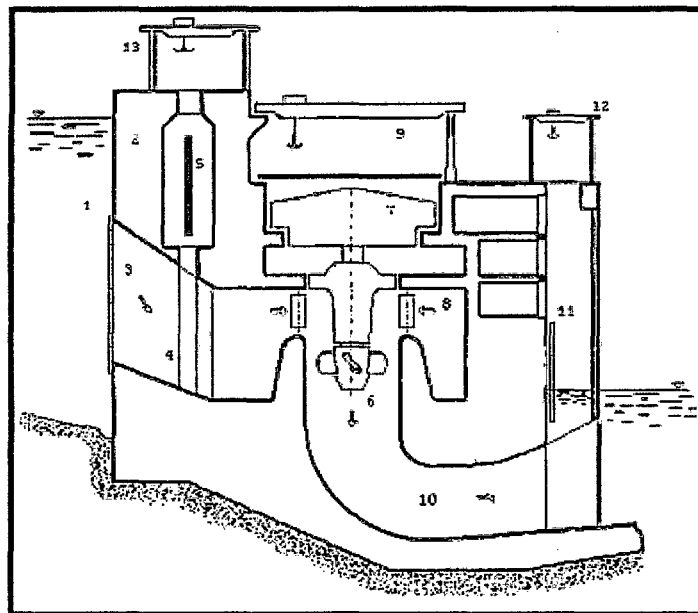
Casa de Máquinas de una central de elevado caudal y baja caída.
